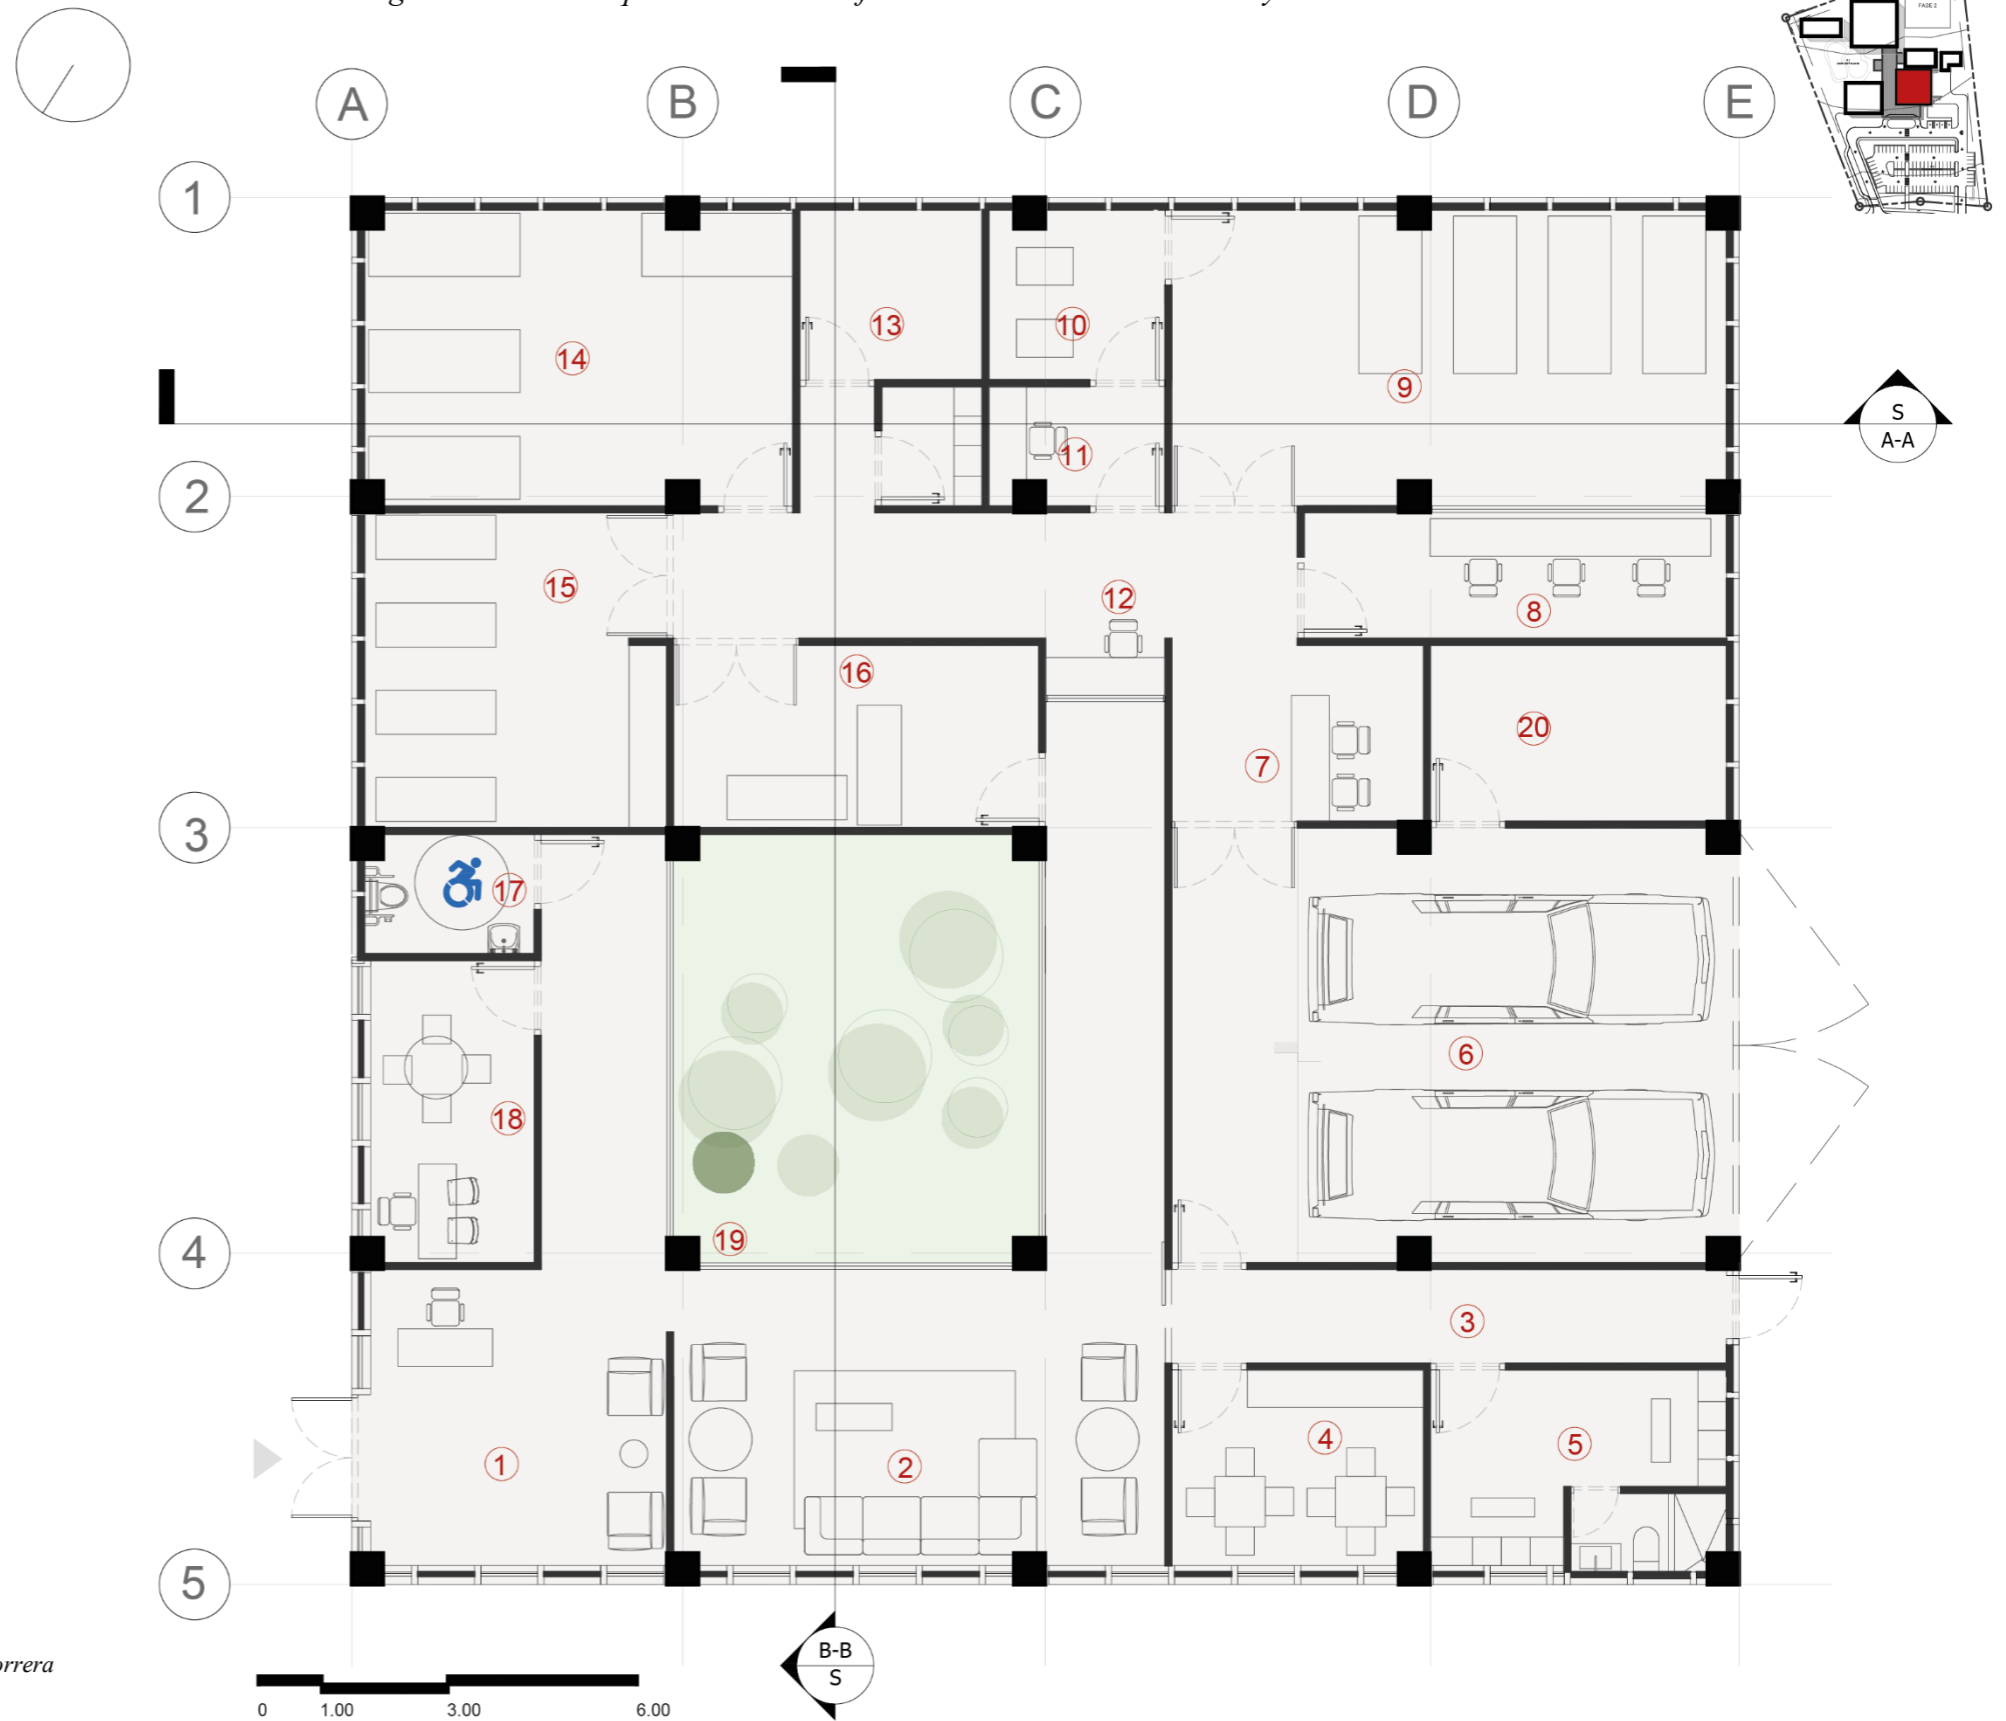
Planta arquitectónica del Edificio 1 de Administración
